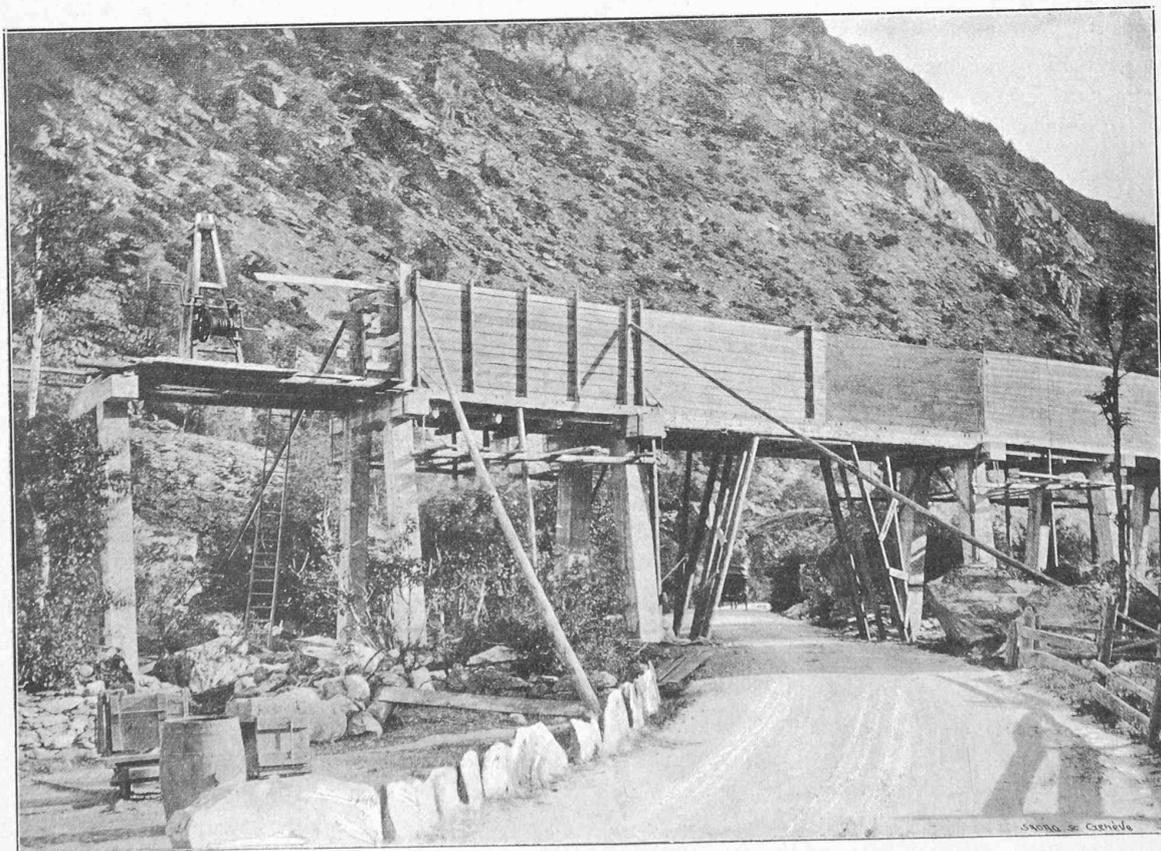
CONSTRUCTION DU CANAL EN CIMENT. (Travée de 10 mètres au passage de la route de la Furka).
